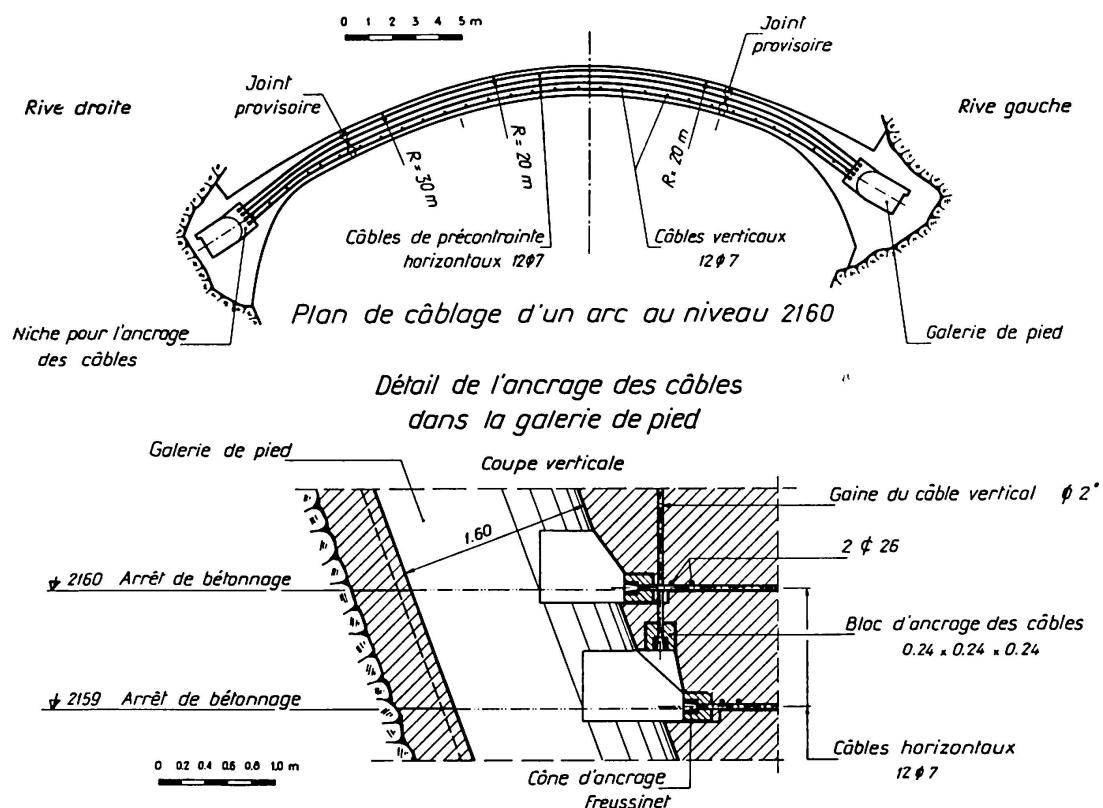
Câblage horizontal. Détail de l'ancrage des câbles.
